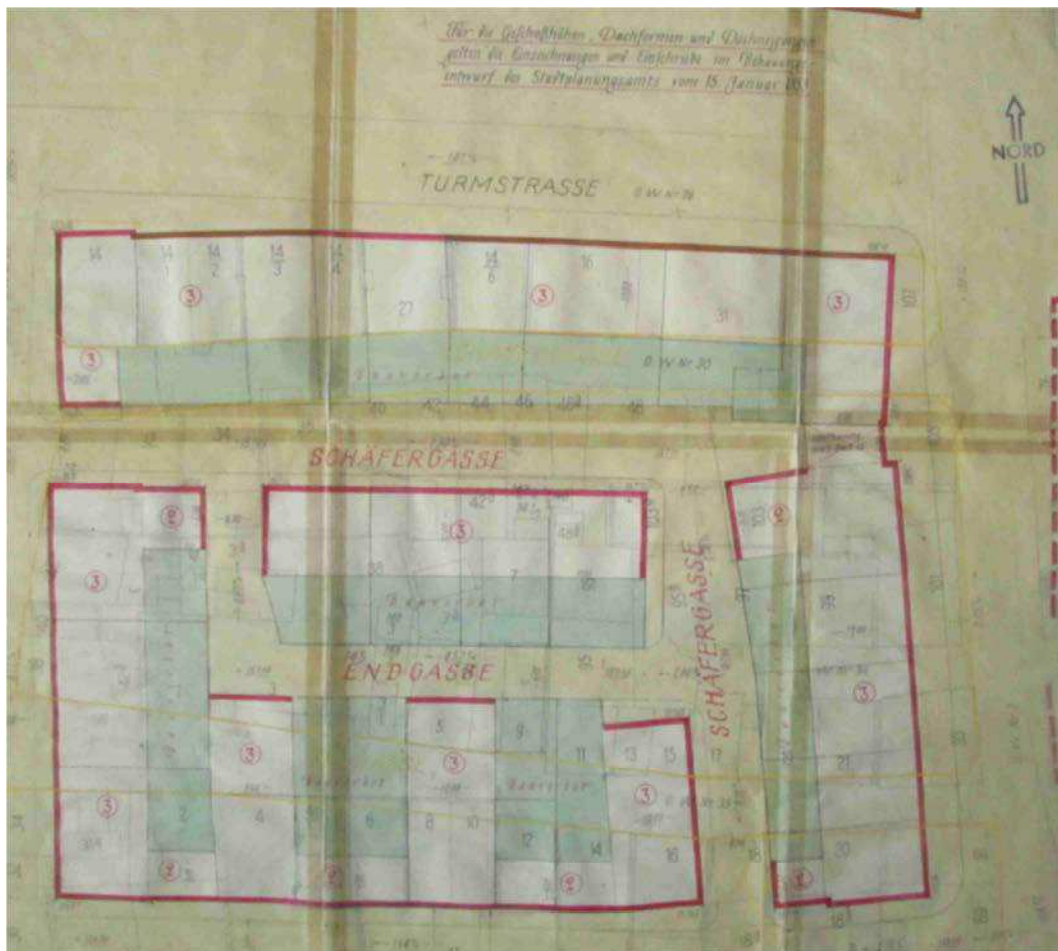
Aufbauplan von 1953 (Ausschnitt). Rot-Baulinien. Grün-Bauverbot. Die ursprüngliche Bebauung und Straßenführung ist noch eingezeichnet. Quelle Planungs- und Baurechtsamt Heilbronn.
